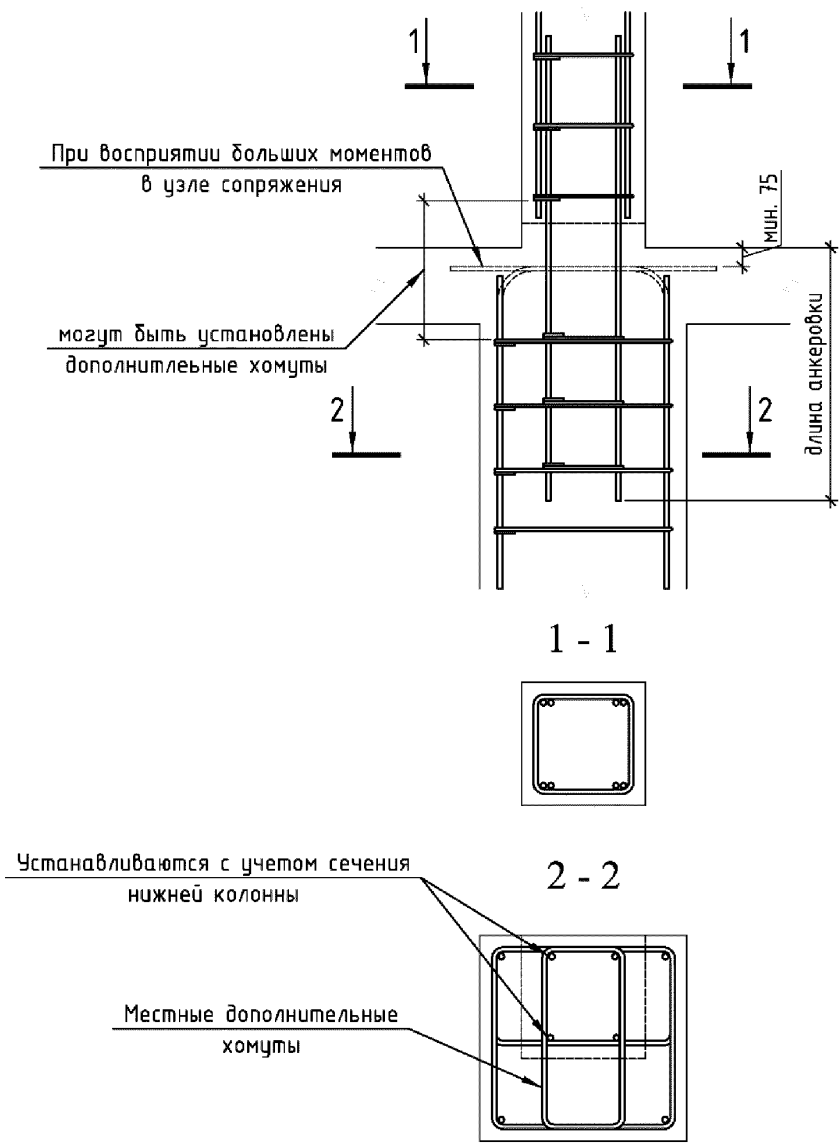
Узел сопряжения колонн разного сечения и плиты перекрытия
